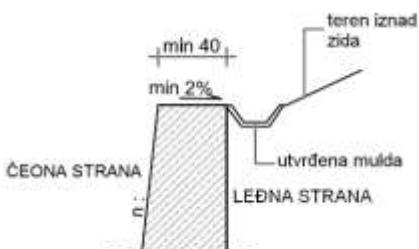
Detalj betonskog zida sa naknadnim oblaganjem
